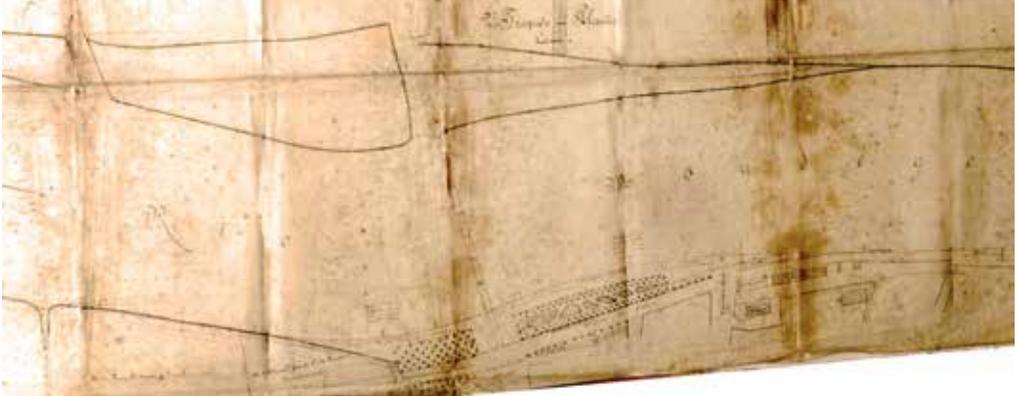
Excerto do desenho da 2.^a Circunscricção Hydraulica, *Projecto do alargamento do Caes de Coimbra, Plantas. 2.^o Traçado - Planta*, 14 de dezembro de 1887 (ARHC, n.º 1) Esta hipótese propunha um aterro correspondente a dois pilares da nova ponte, aproximadamente 36,5 metros
